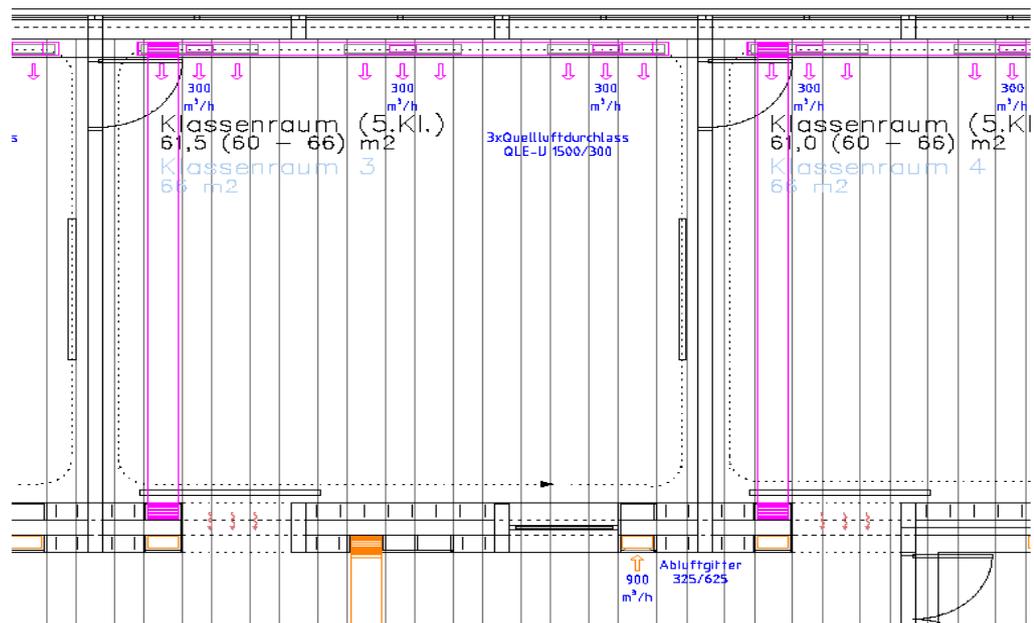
Planausschnitt Luftführung in Klassenräumen
